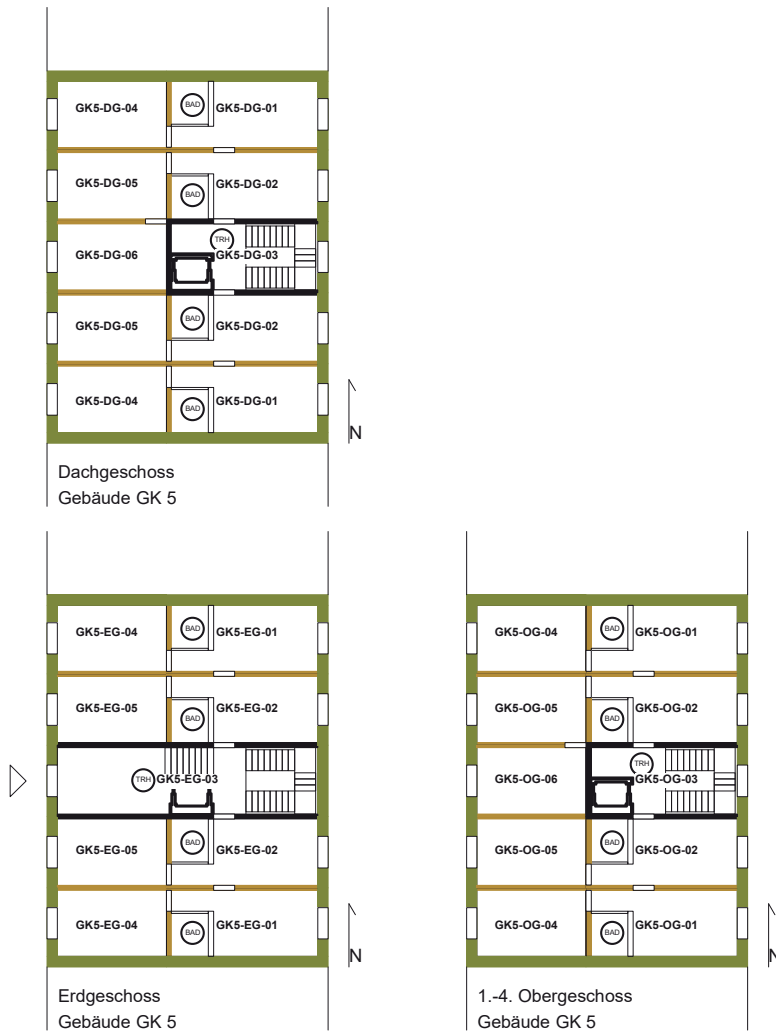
Grundrisse Grobentwurf Baulücke Gebäudeklasse 4 (GK 5)
